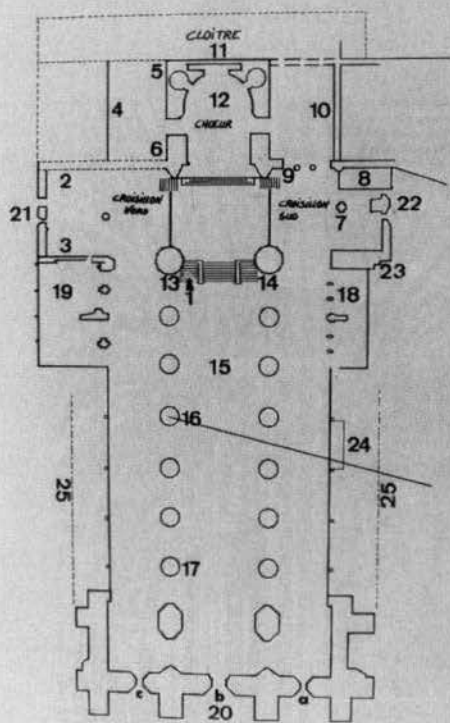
Grundriß des „Alt Straßburg Münsters“, 1386
